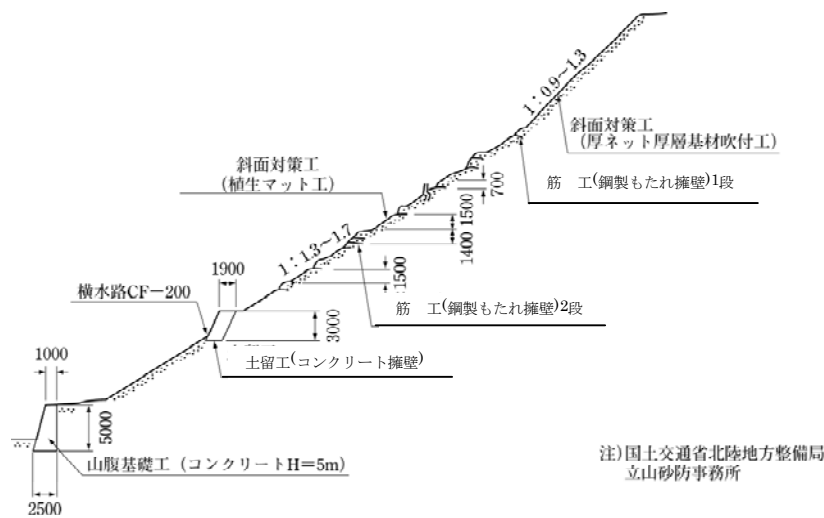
植生基礎工を主とした山腹工（施工例）
